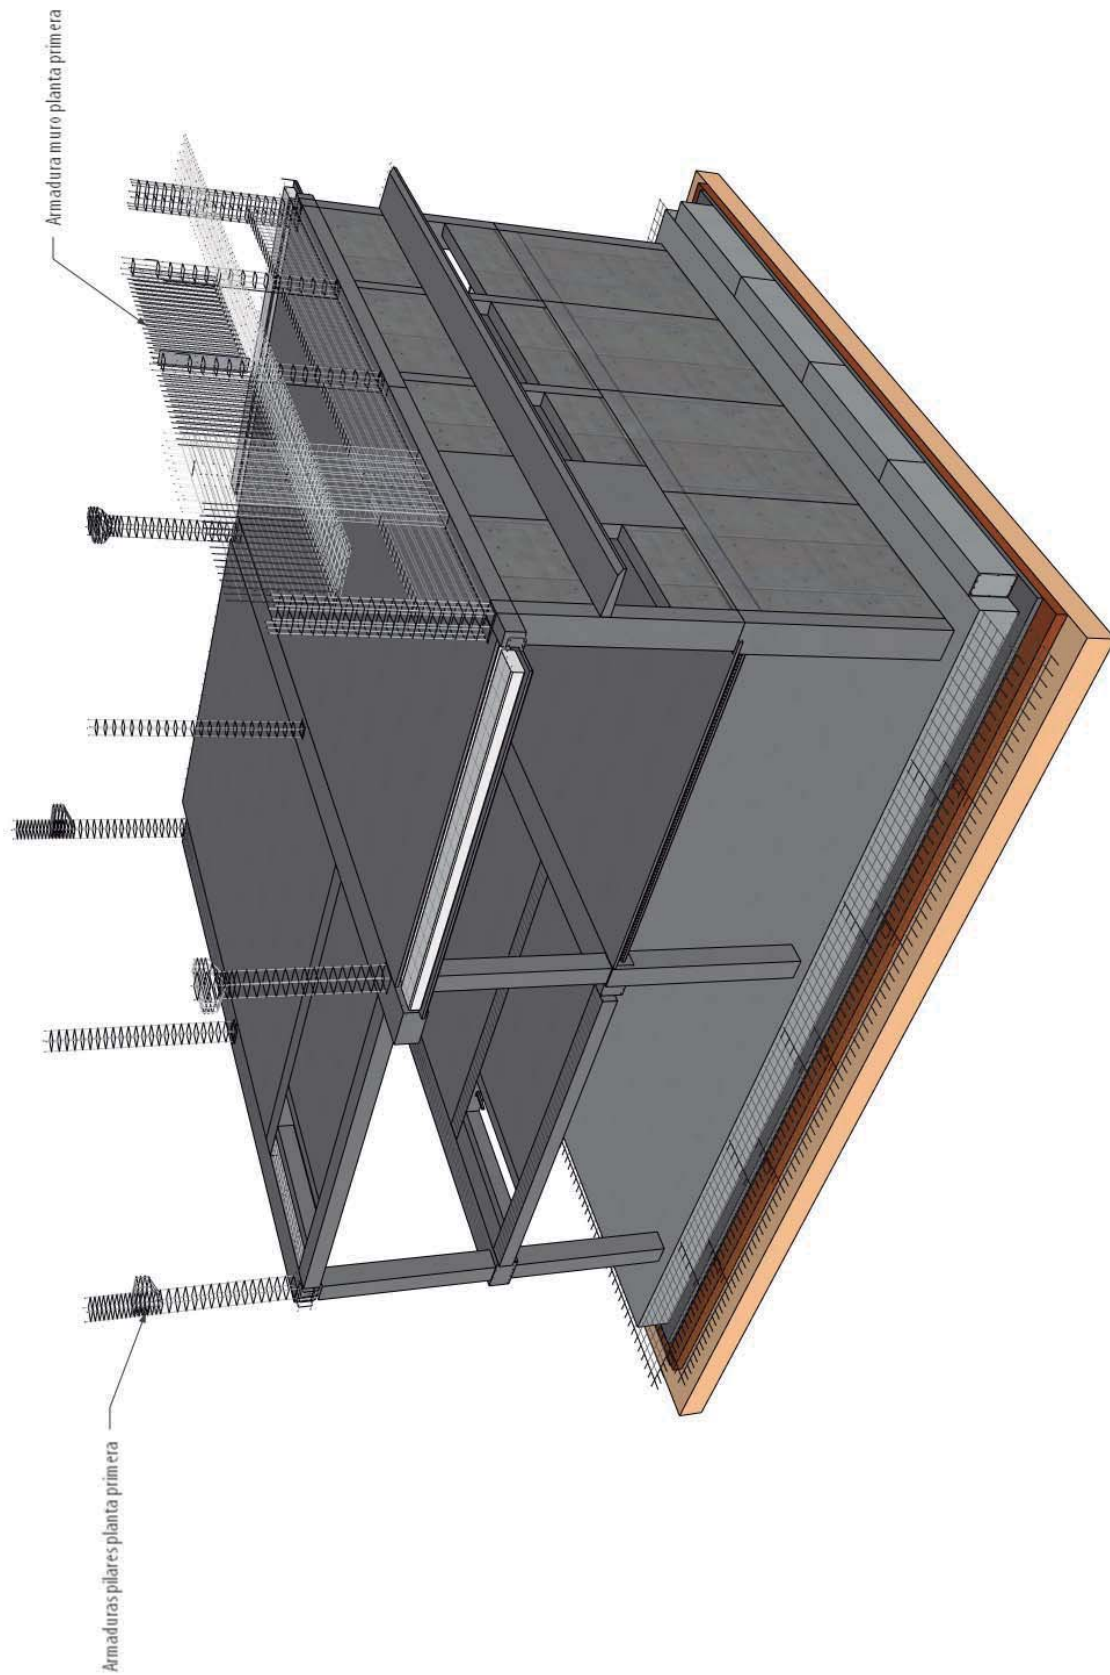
Colocación de las armaduras de los pilares que soportarán la estructura metálica
